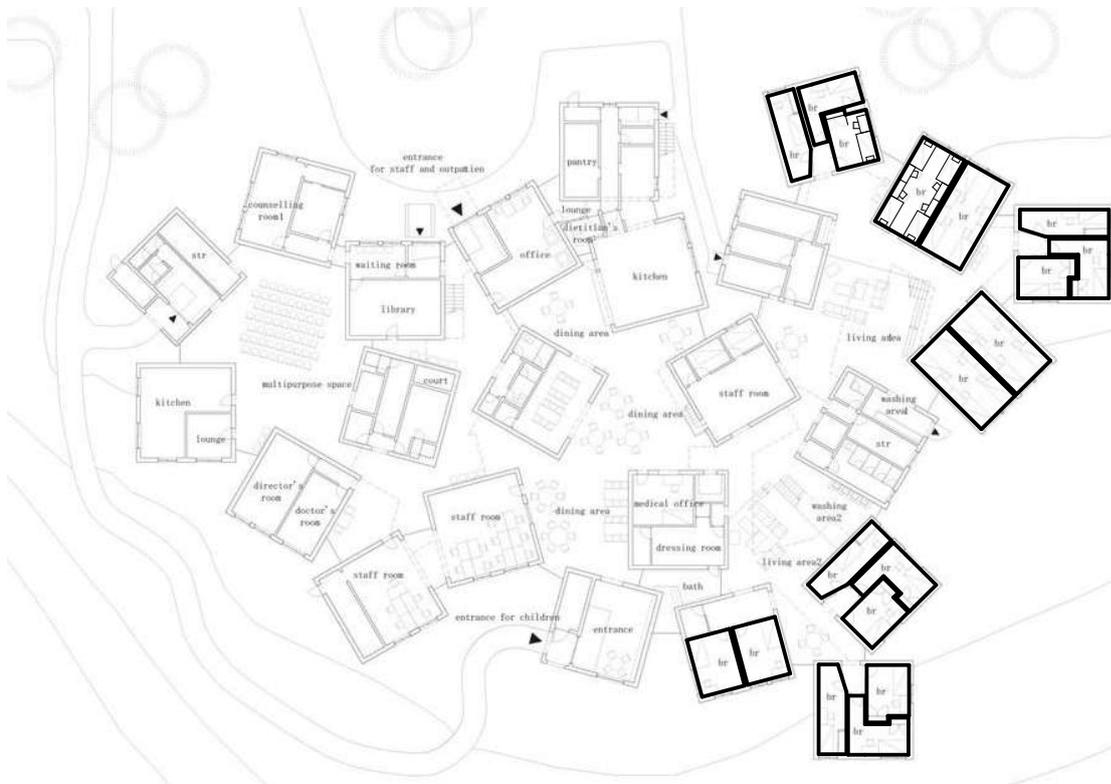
Grundriss Erdgeschoss M 1:500
